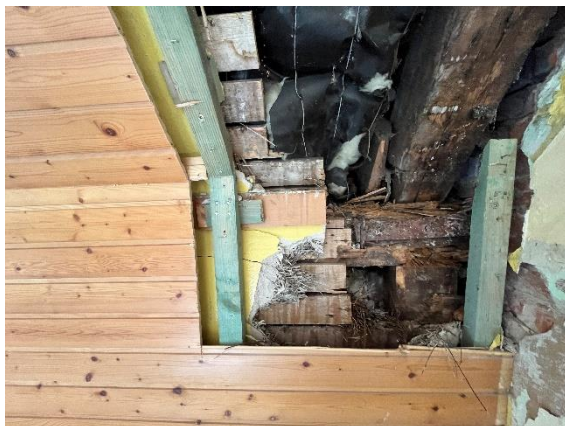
DG: Bauteilöffnung Dachschräge (KMF u. Rabetzputz)
